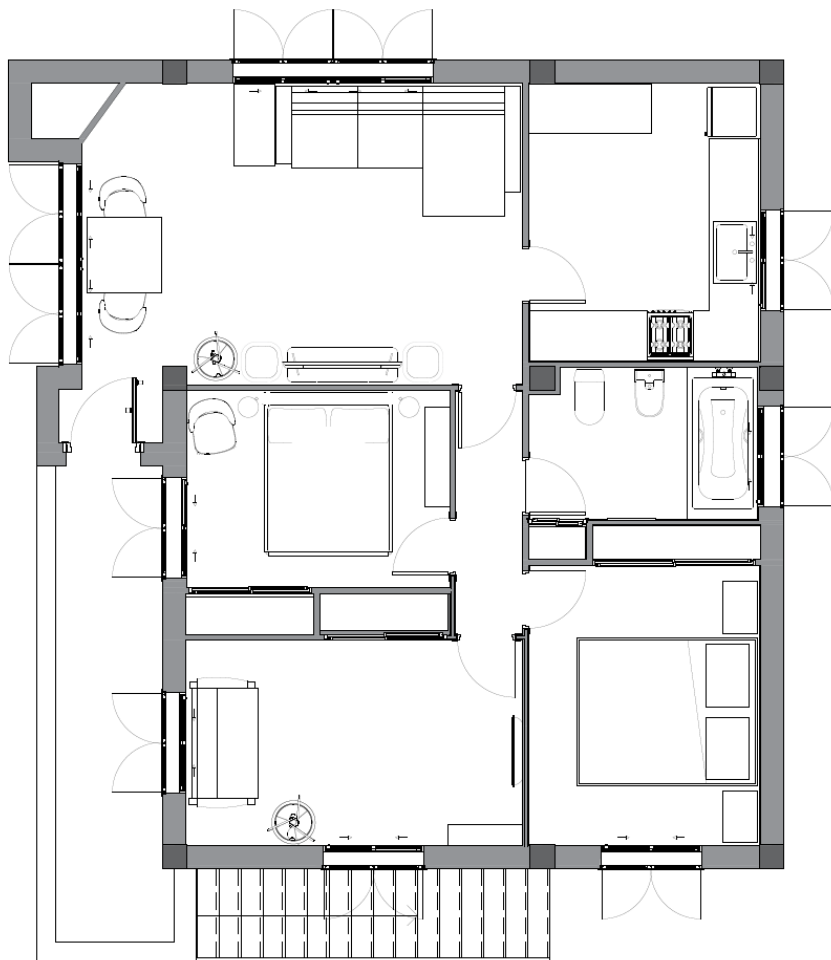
Plano estado actual de la vivienda - primera planta. Fuente propia
